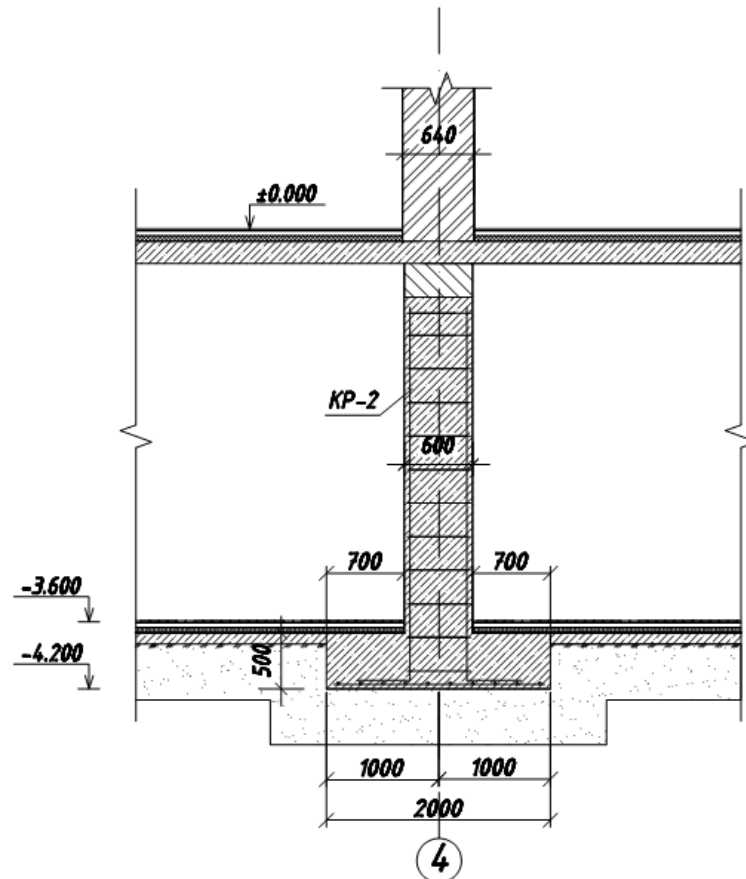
Стрічковий фундамент в перерізі 2-2
